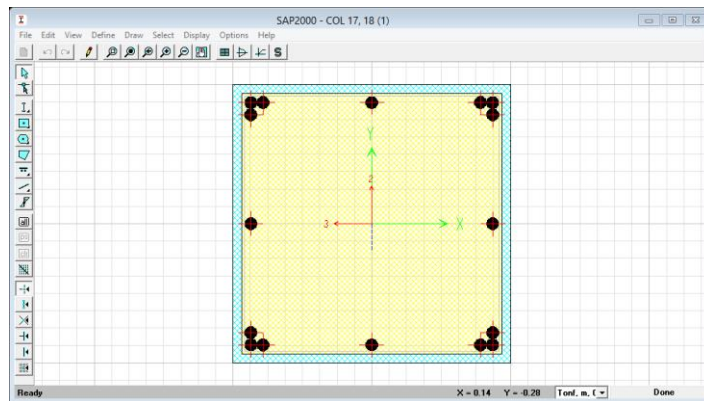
, Configuración de refuerzo columna, Section Designer, SAP2000, Edificio BCO CENTRAL
